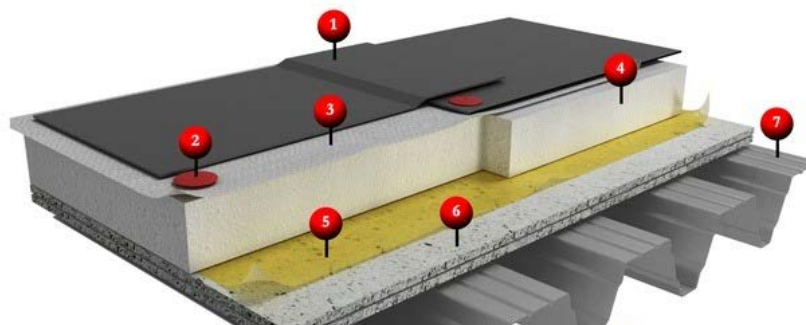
Ограждающие конструкции кровли покрытия здания
